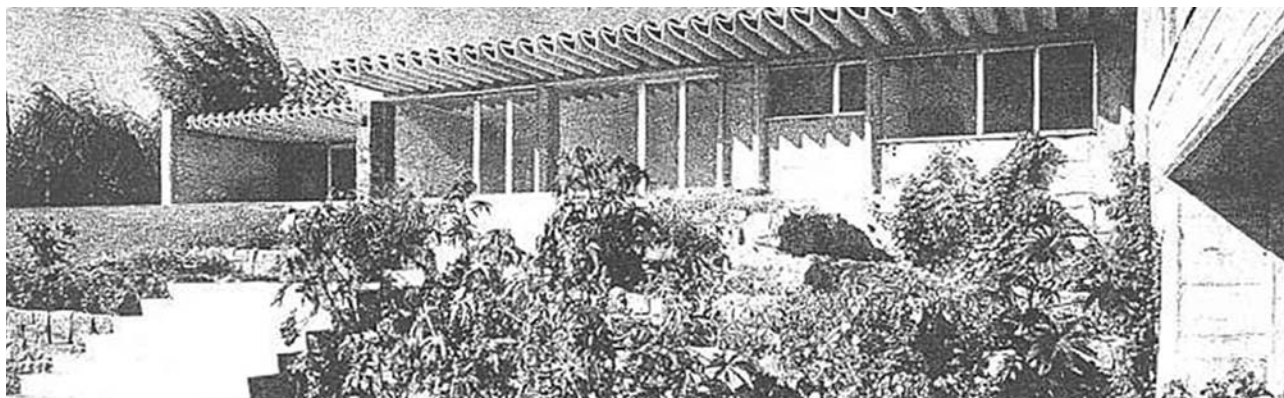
Aplicación de piezas huecas a cubiertas y forjados.
